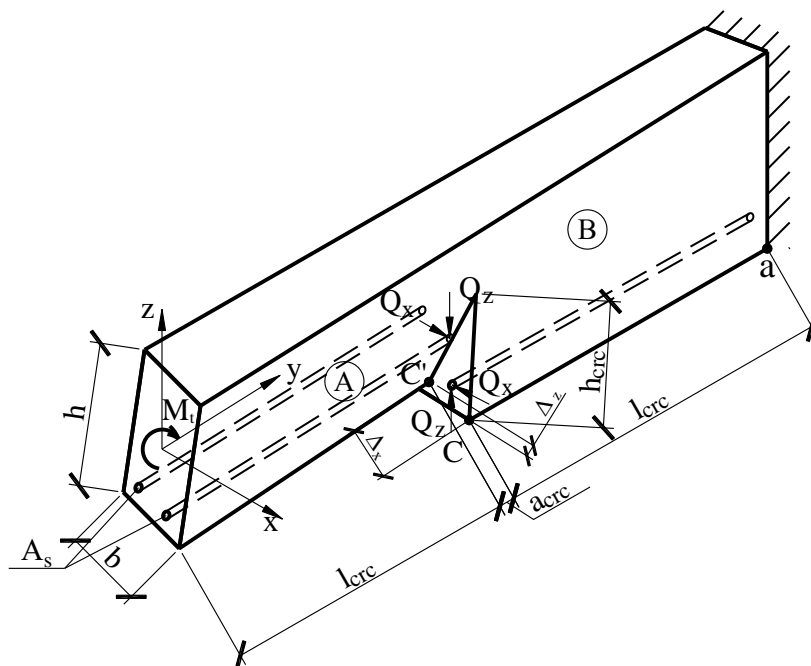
Схема переміщень в перерізі з нормальною тріщиною і зусиль в поздовжній арматурі елемента, на який діє крутний момент
